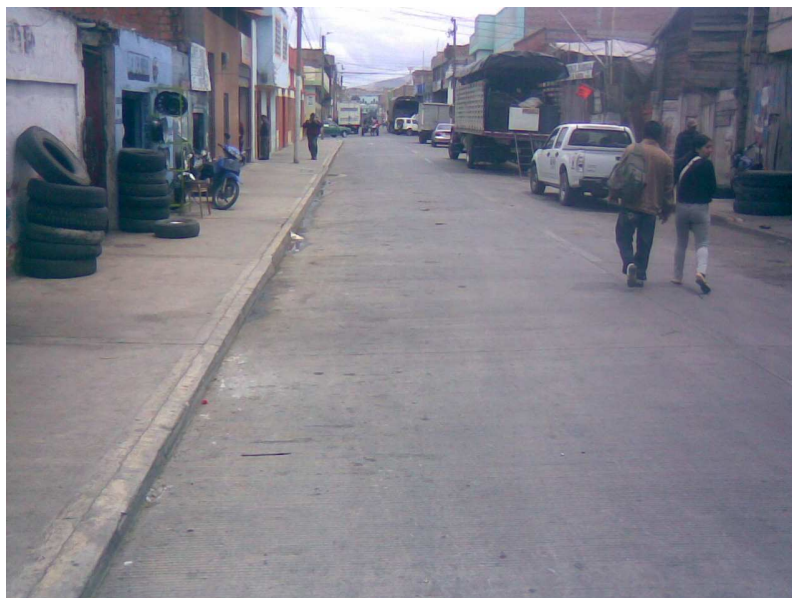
Vista de la calzada y andén contruidos sobre la calle 15
